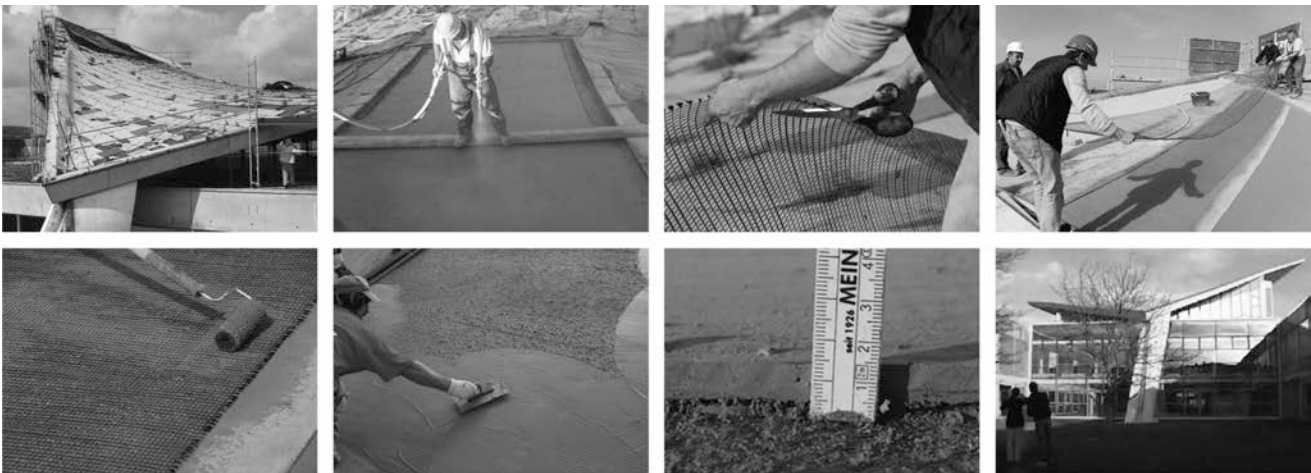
Aplicación del hormigón armado con textiles en el refuerzo de una cubierta laminar paraboloide hiperbólica en Schweinfurt, Alemania, [14]
